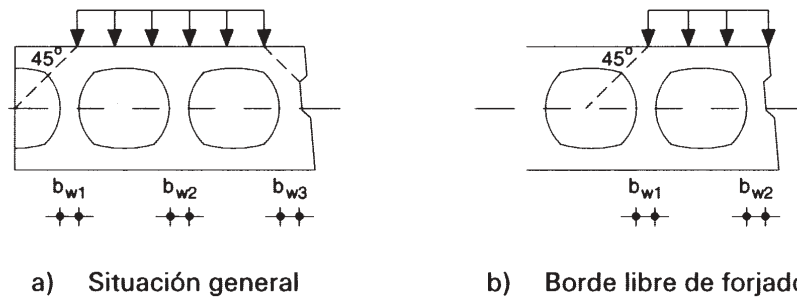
Ancho efectivo en losas alveolares pretensadas
